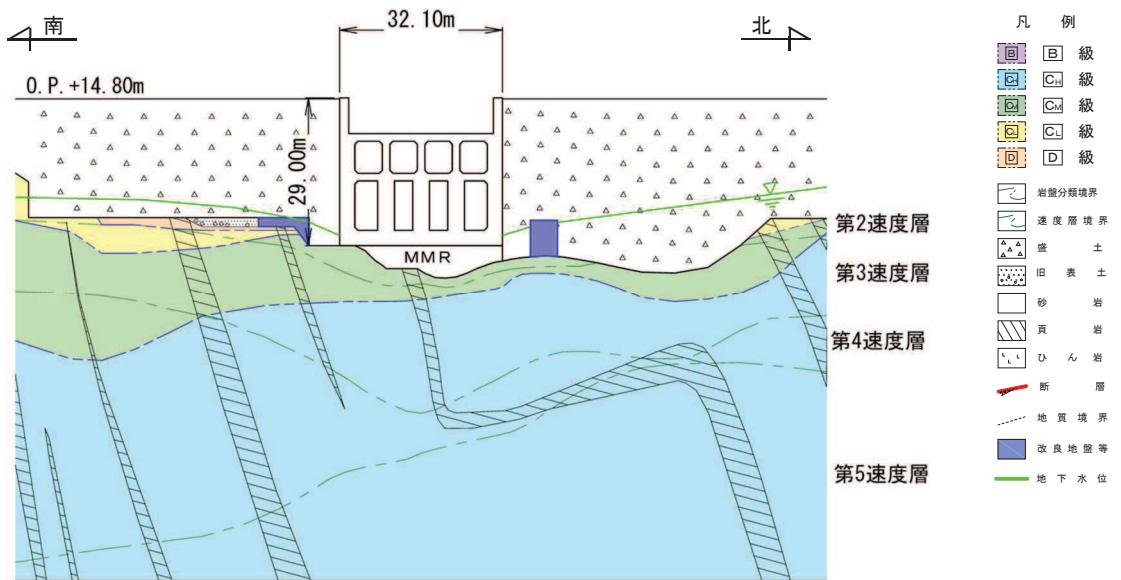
第 3 号機海水ポンプ室地質断面図 (B-B)
